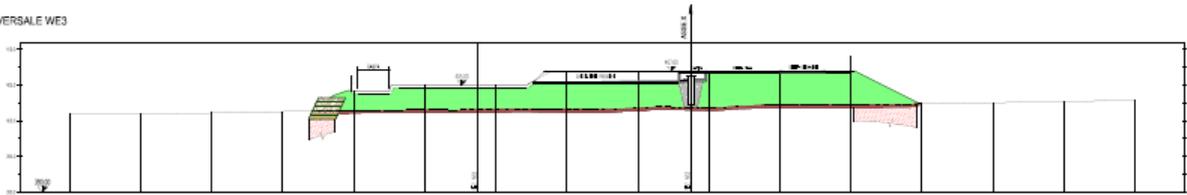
Sezione trasversale dell'opera con evidenza delle opere di sostegno da elaborato di progetto
